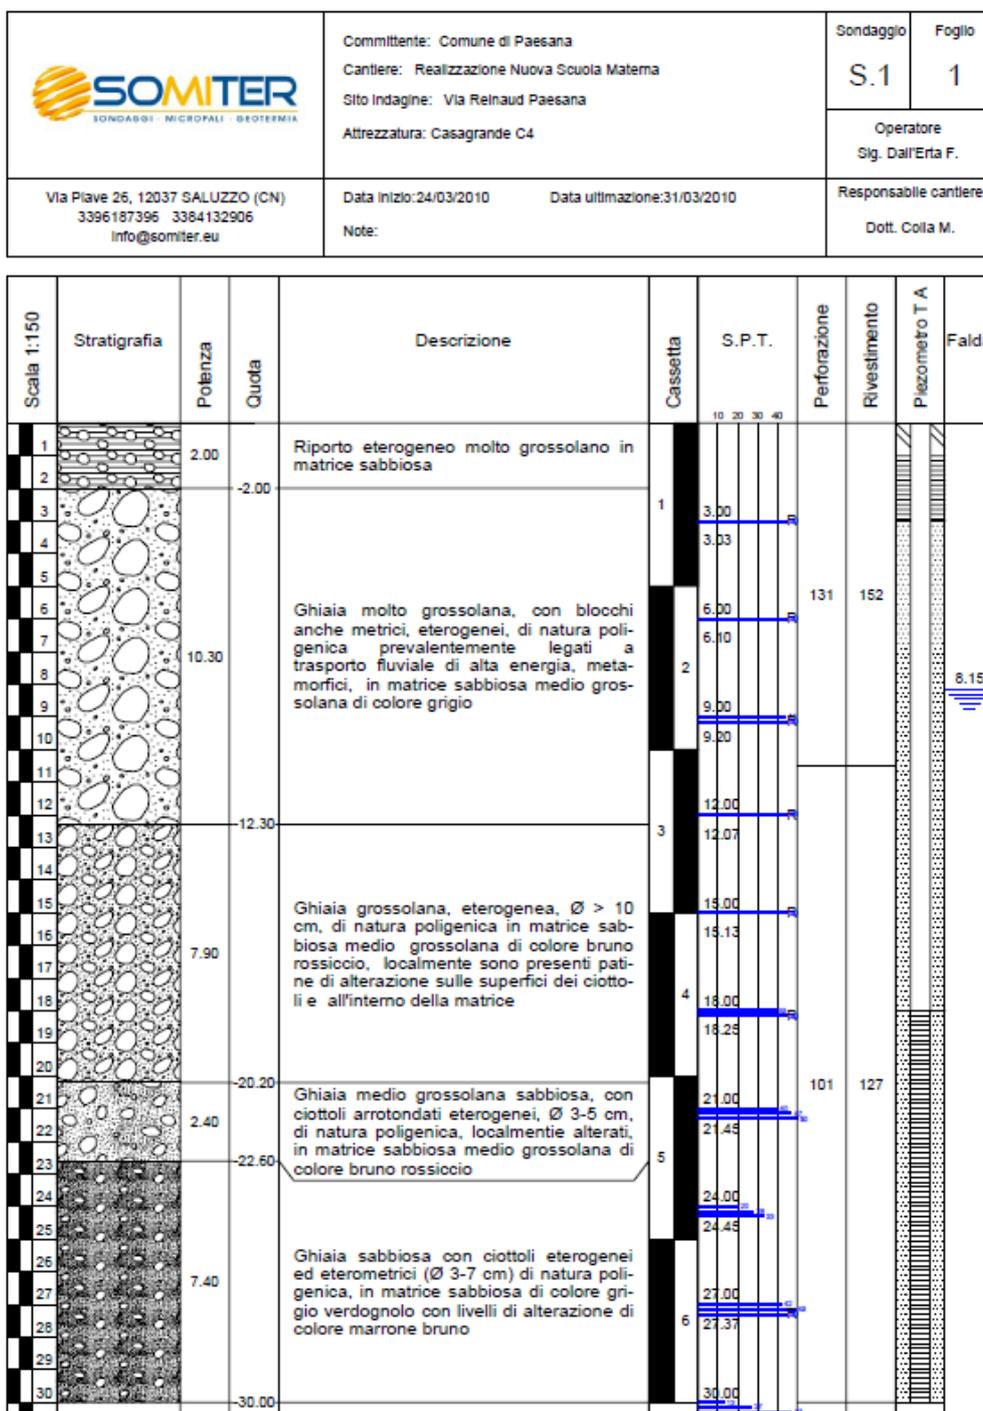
Sondaggio eseguito dalla ditta Somiter presso il cantiere di Via Reinaud.
